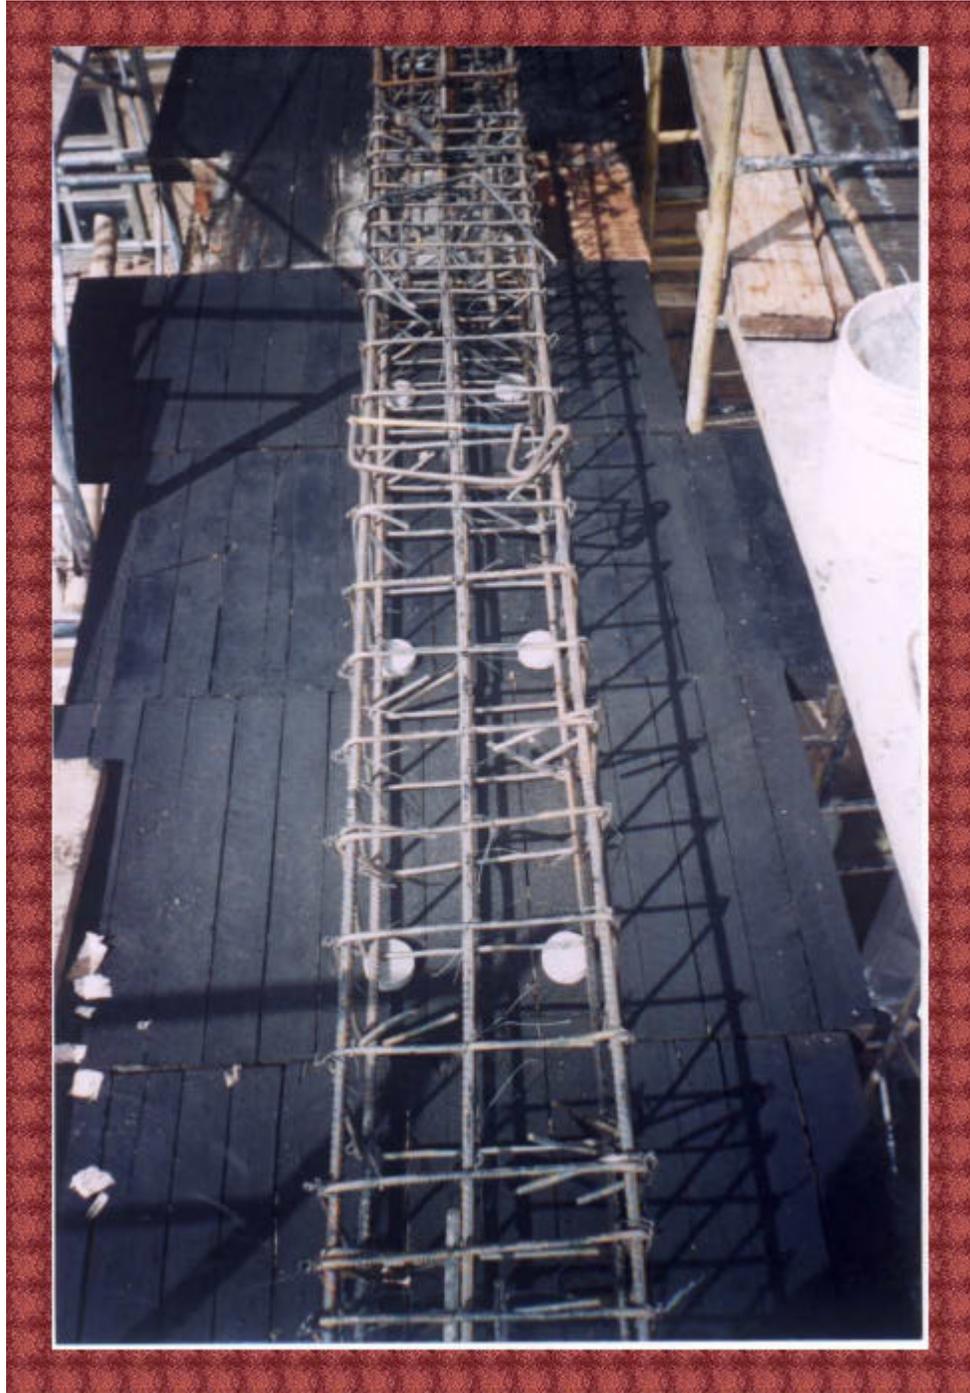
Se aprecia casi en su totalidad toda la estructura de concreto reforzado
